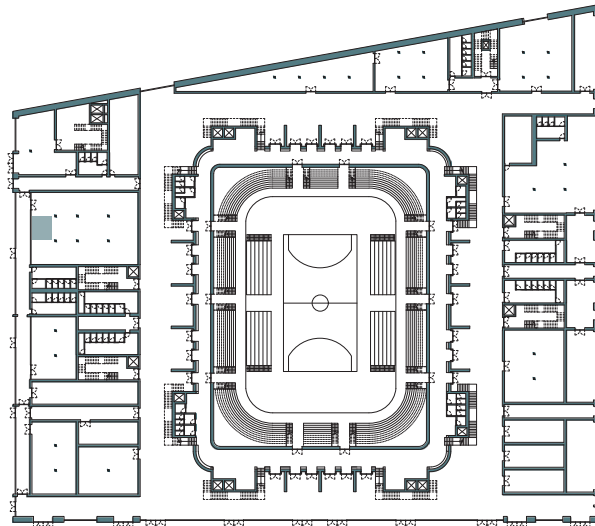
Pianta piano terra e individuazione uffici caso studio
